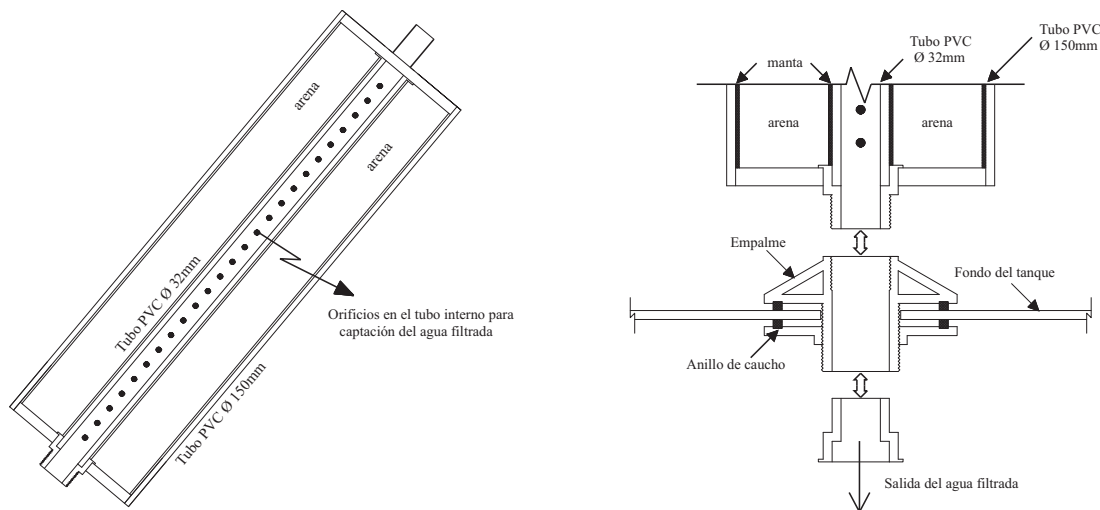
Detalles de las columnas de filtración con manta y del adaptador roscado de las columnas verticales de filtración.
